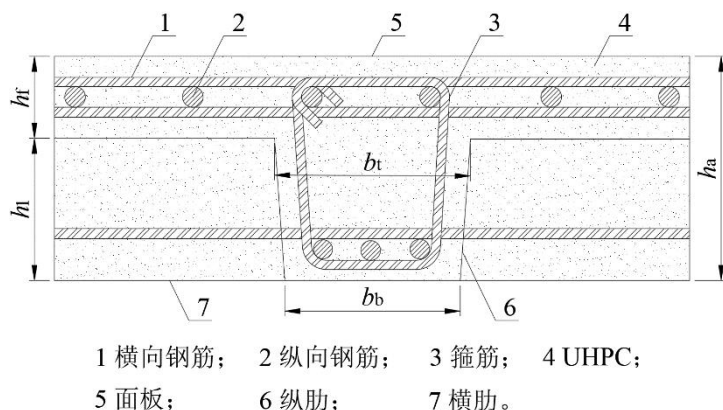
超高性能混凝土华夫板尺寸示意图
